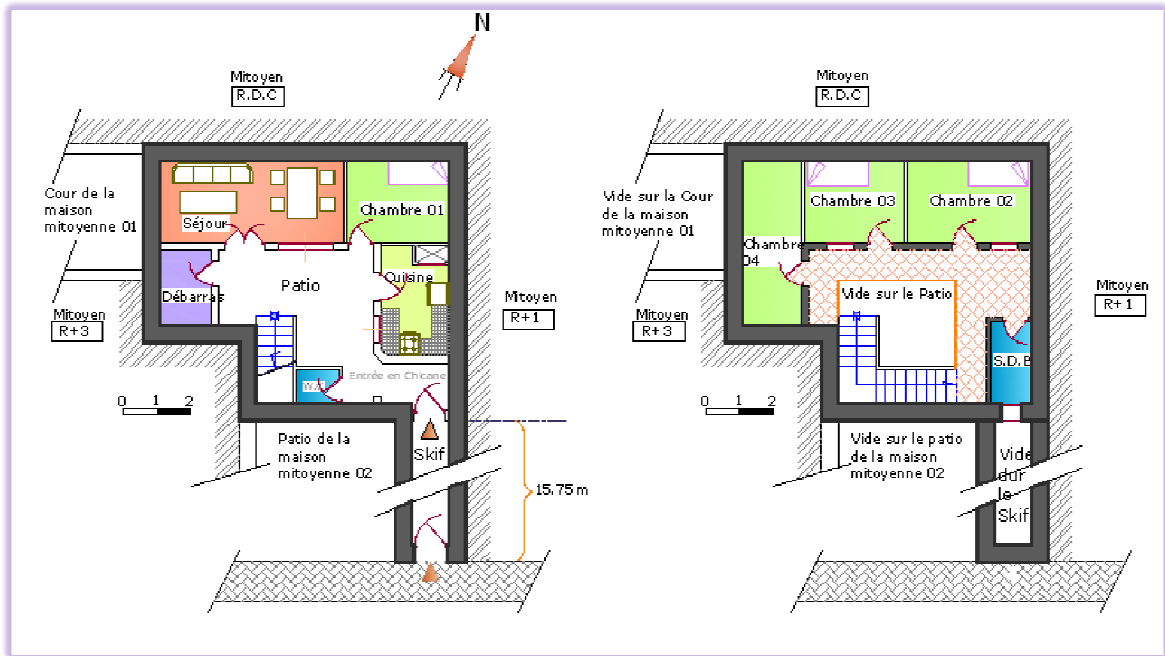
Plan R.D.C (à gauche), Plan 1^{er} Étage (à droite), (Maison N°5)
